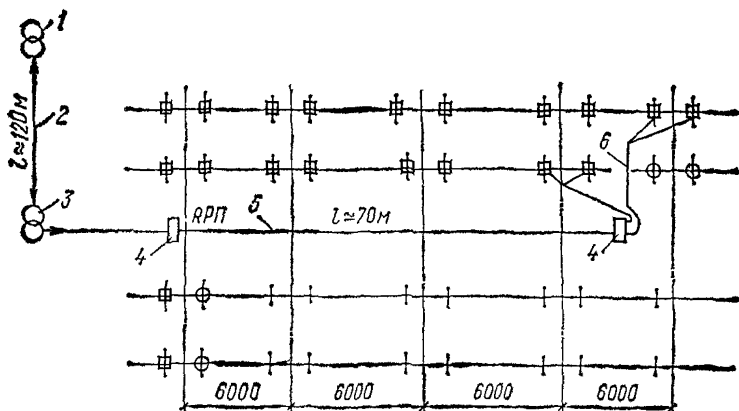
Схема размещения оборудования для электропрогрева свай
